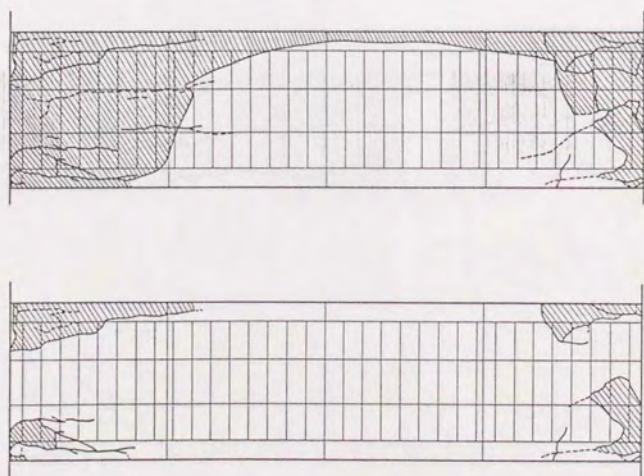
ひび割れ状況 (試験体 85)
